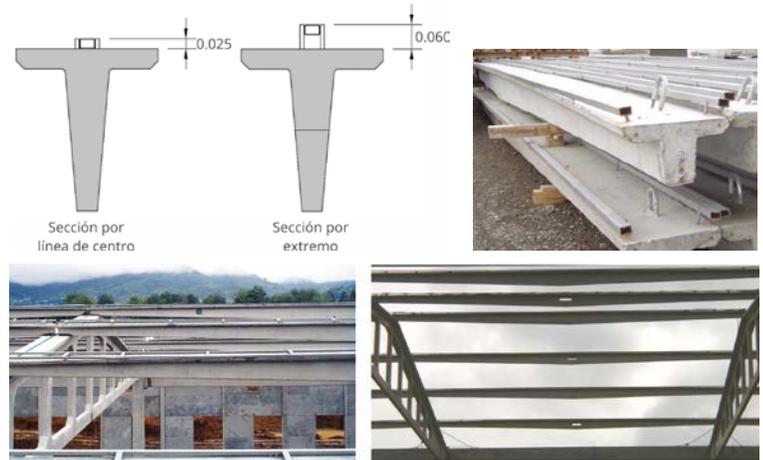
Detalles de ubicación del tubo industrial para la lámina de techo
